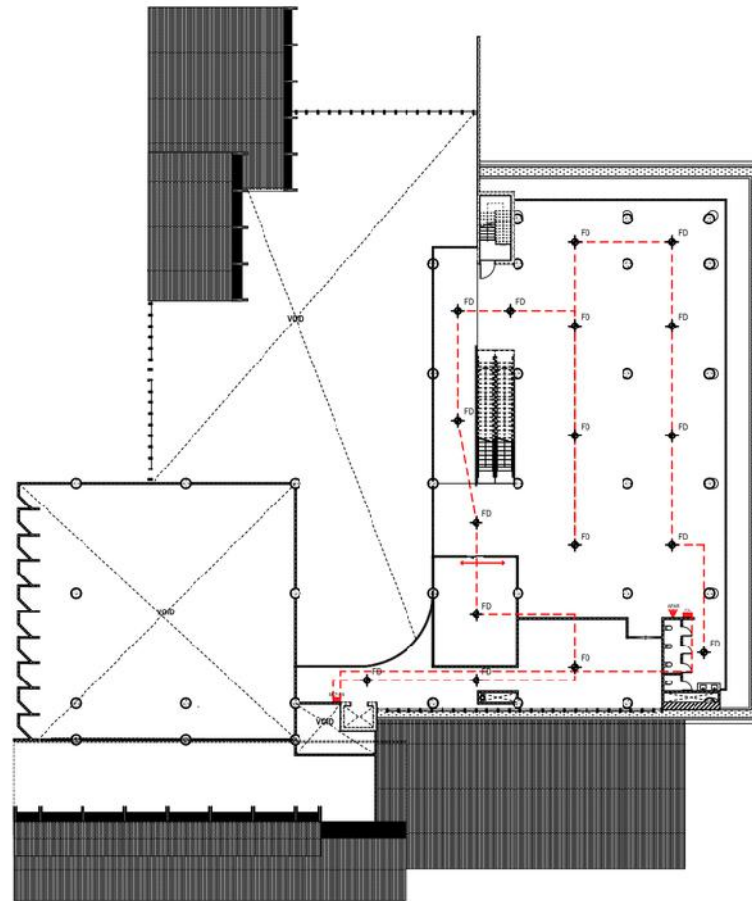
Rencana Fire Alarm Lantai Dasar
